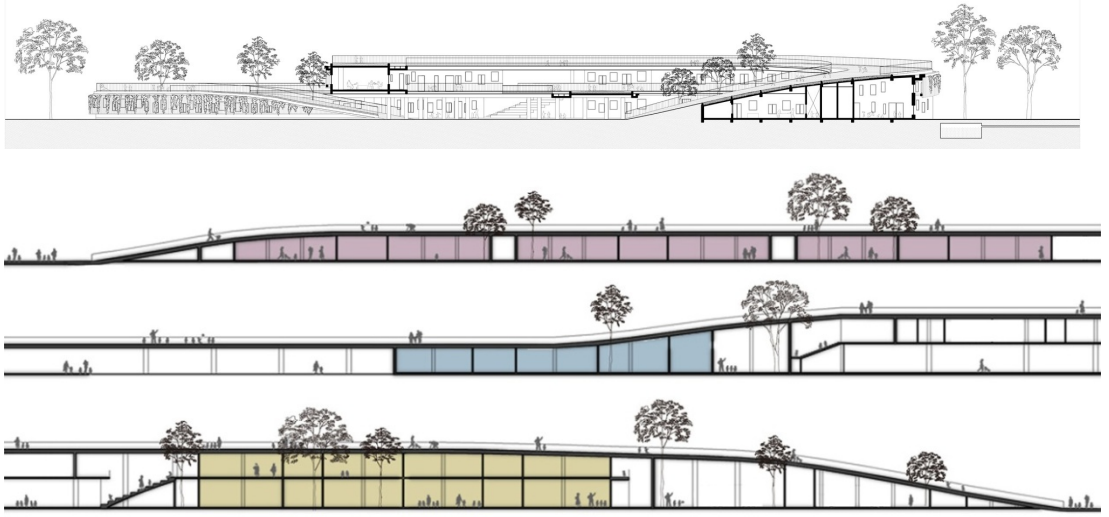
Tarım Anaokulu vaziyet planı ve yerleşim planları (Anonim 2021m)
